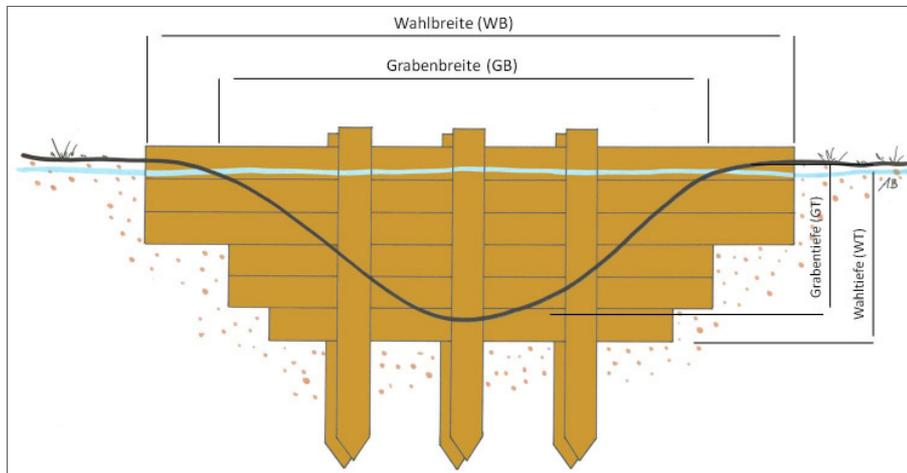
Stammarmierter Torfdamm (RQ), Frontalansicht
